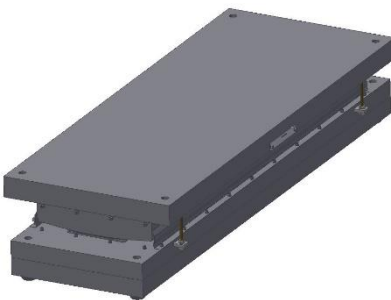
Lagertyp LKf, Lastübertragung über Scherdübel, oben Stahl & unten Betonanschluss.
